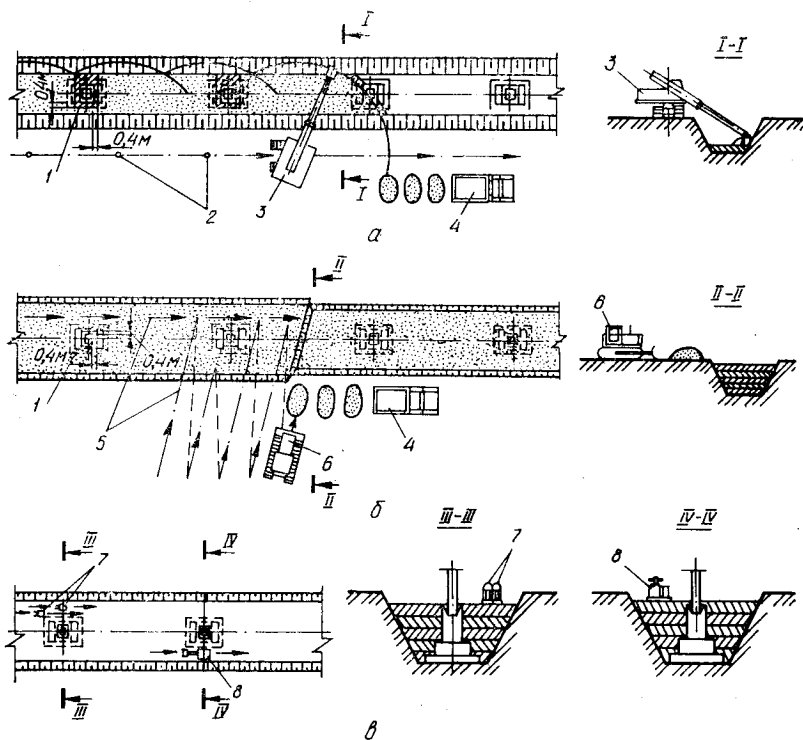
Схемы уплотнения грунтов в траншее под фунданты колонн:
